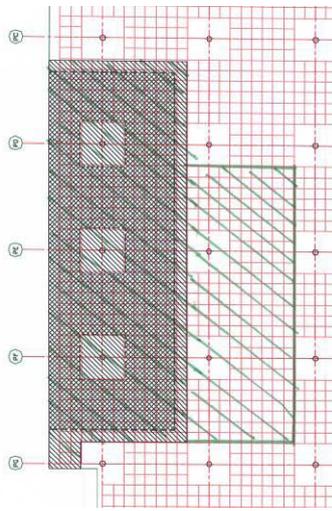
Izquierda: Zona a demoler en planta 4 del modulo C
